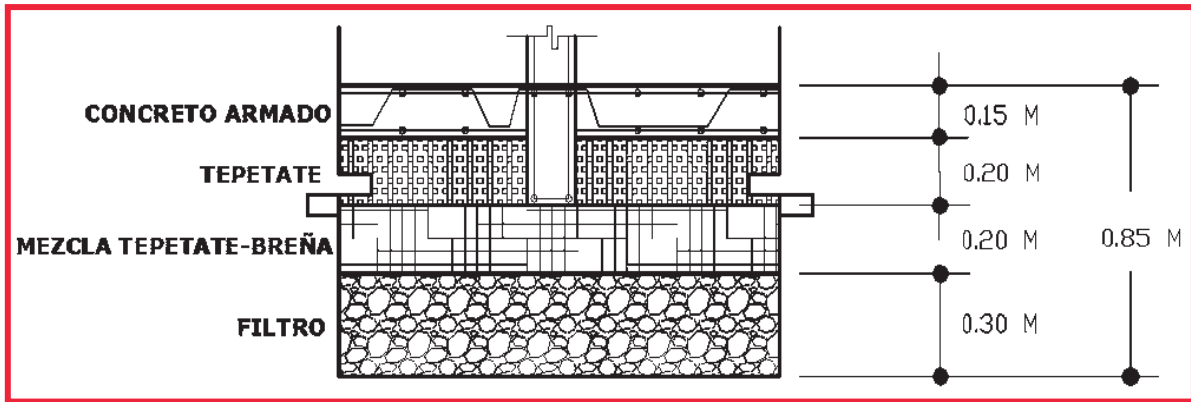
Detalle de losa de Cimentación. Origen: Dibujo de autocad, marzo 2010.
